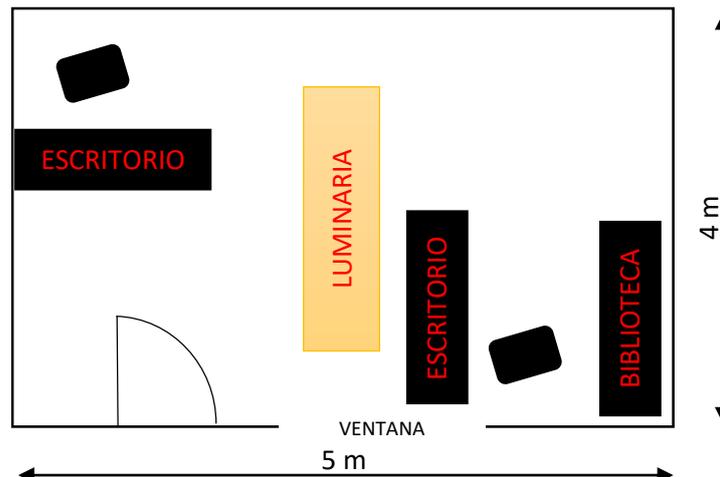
Sector 1 – Oficina Hormigonera Villegas S.A.
